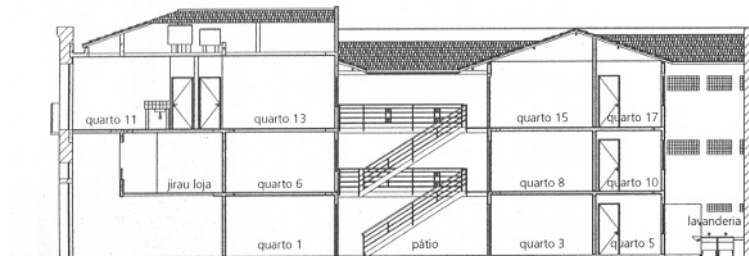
Cortiço na rua Sacadura Cabral, 295 – Corte transversal (SECRETARIA, 2000, p. 24).
